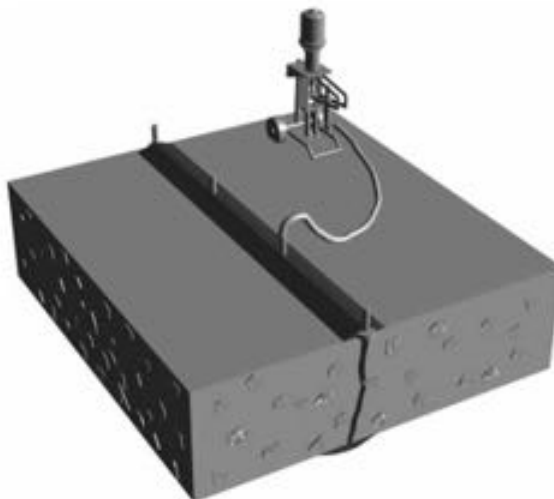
Inyección en el segmento más ancho de la fisura, hasta que ya no entre más resina y se rebose, figura fuente RAP-1 ACI.
